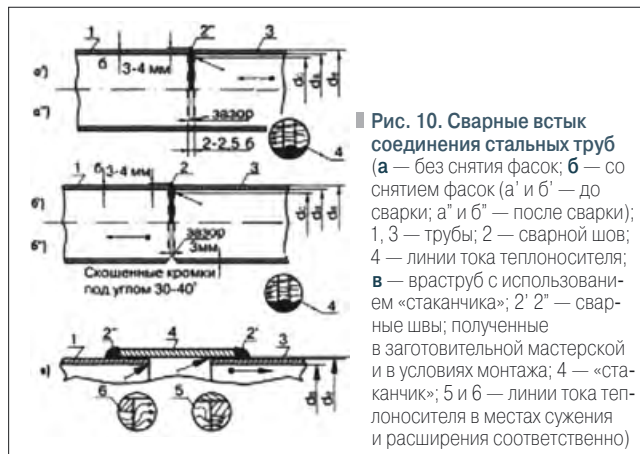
Сварные встык соединения стальных труб (а — без снятия фасок; б — со снятием фасок (а' и б' — до сварки; а'' и б'' — после сварки); 1, 3 — трубы; 2 — сварной шов; 4 — линии тока теплоносителя; в — раструб с использованием «стаканчика»; 2' 2'' — сварные швы; полученные в заготовительной мастерской и в условиях монтажа; 4 — «стаканчик»; 5 и 6 — линии тока теплоносителя в местах сужения и расширения соответственно)
